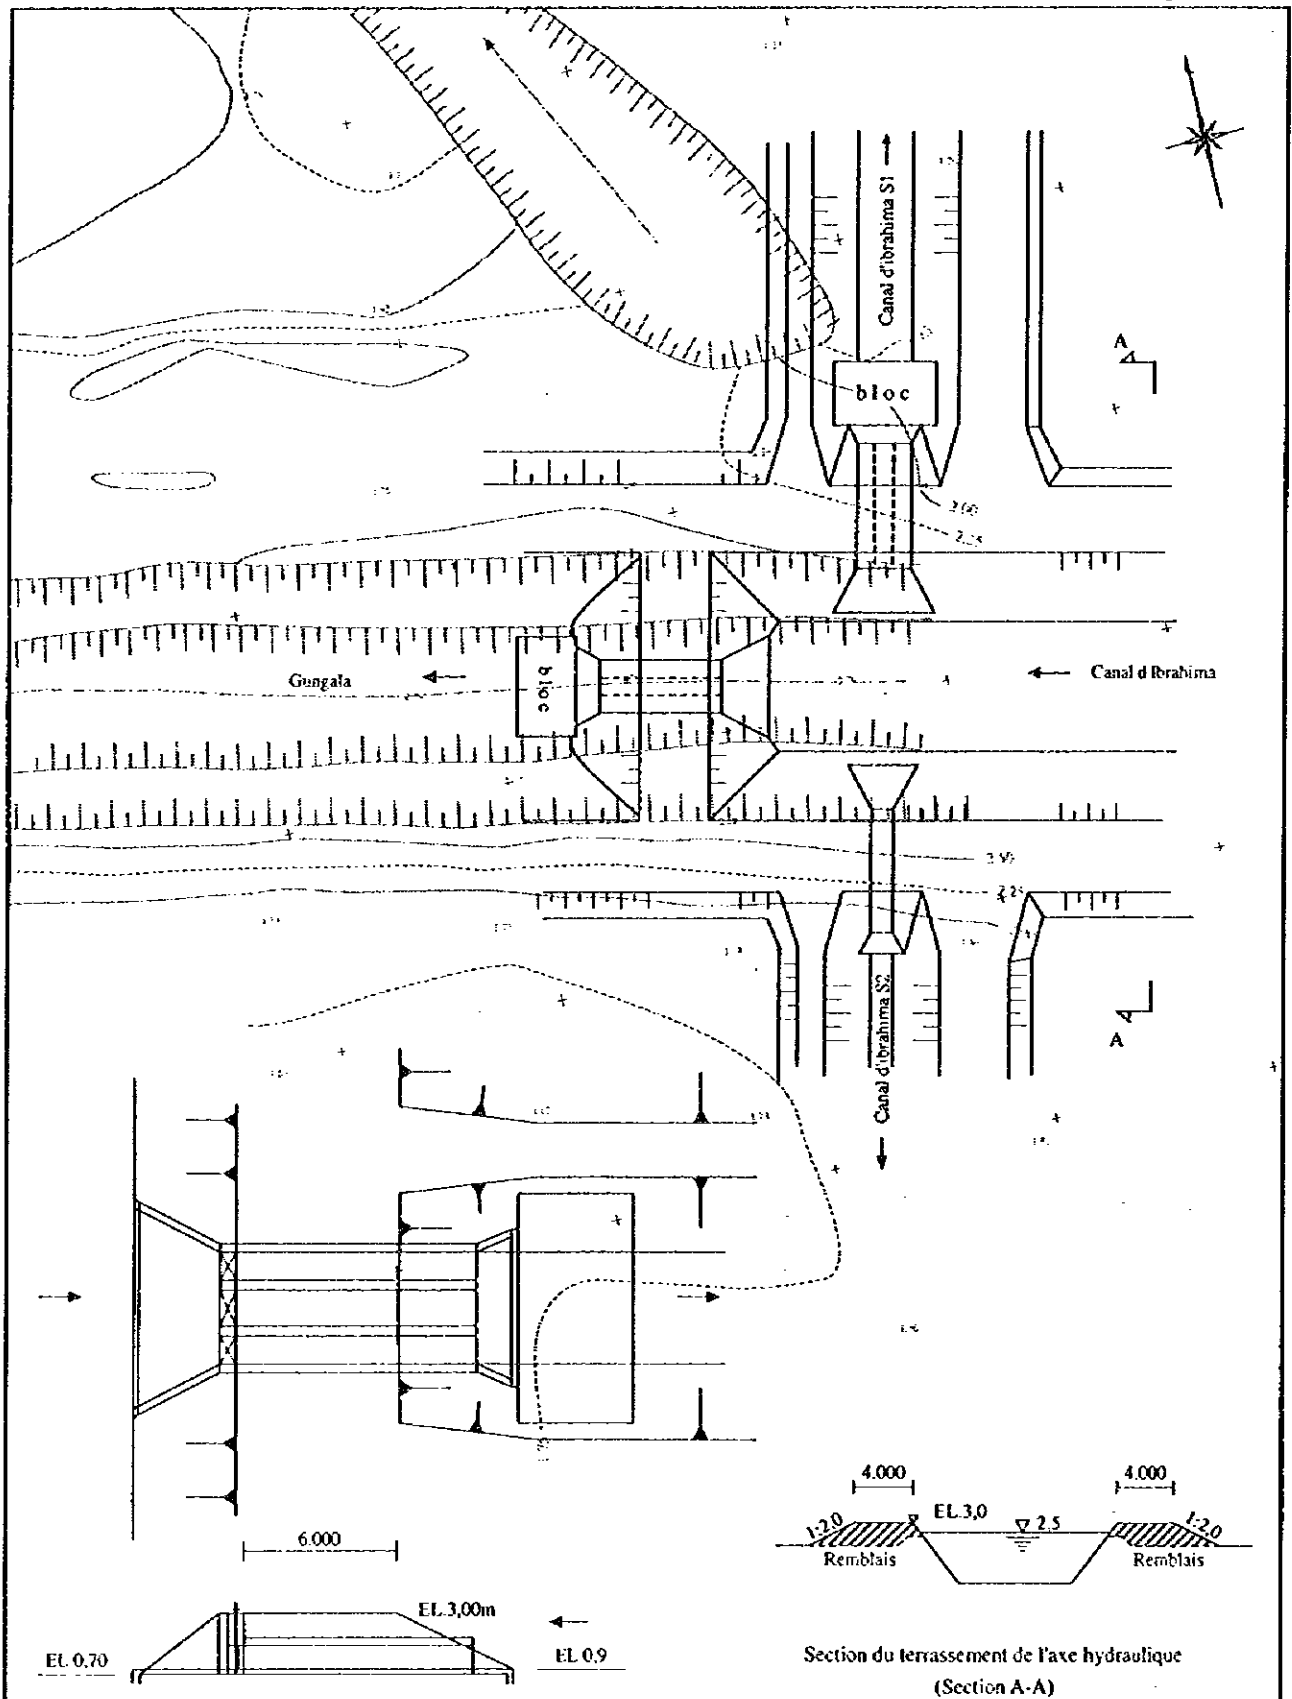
Ouvrage d'Ibrahima et la section du terrassement de l'axe hydraulique
